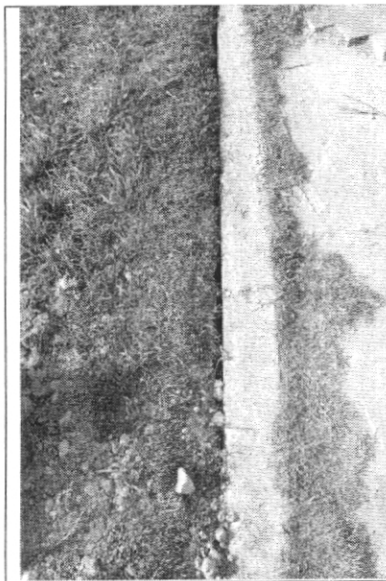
Grietas en el terreno, parte alta (corona) del talud de corte afectado.
